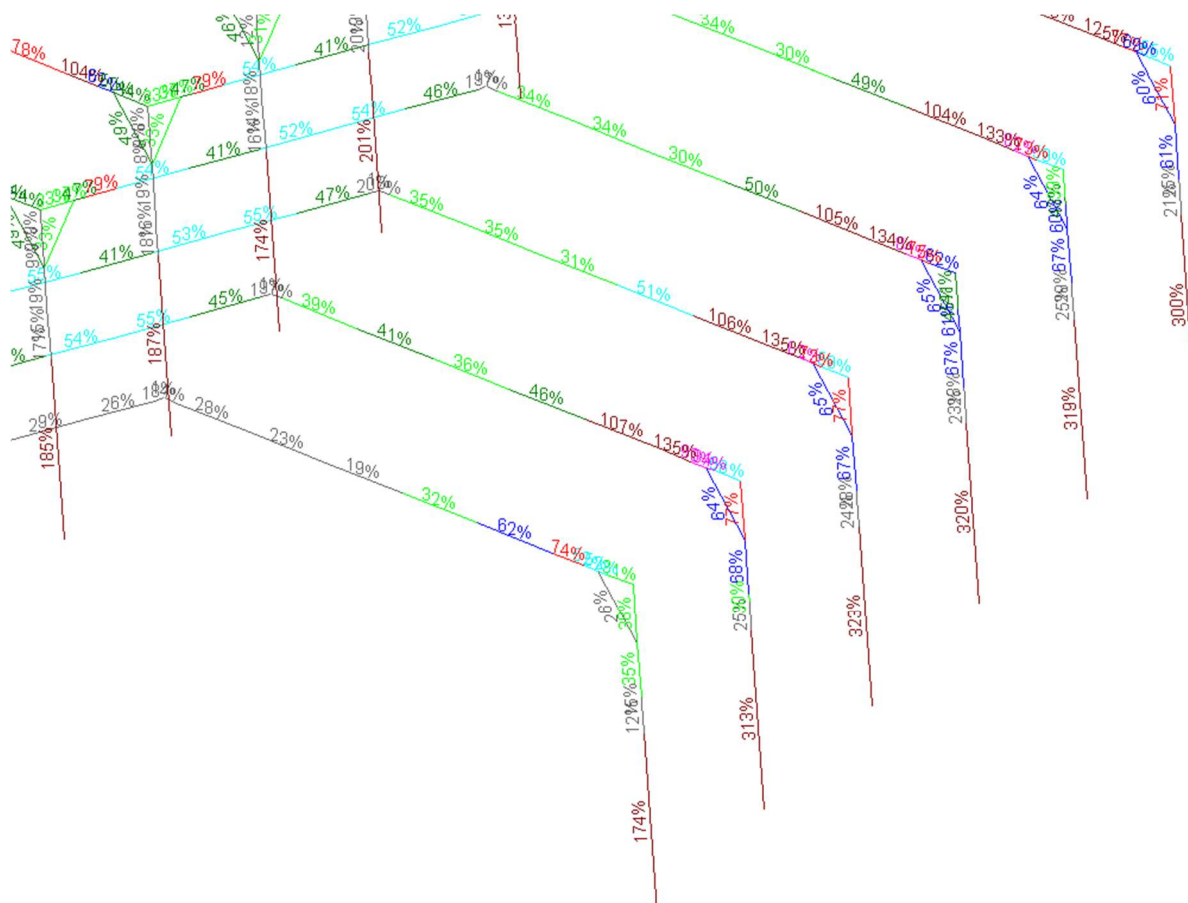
DETALHE 03 - PILARES E TESOURAS
